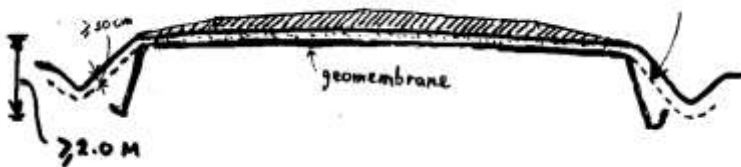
Simulasi Membangun Bangunan di Atas Tanah Timbunan yang Baik (Mochtar,2000)
